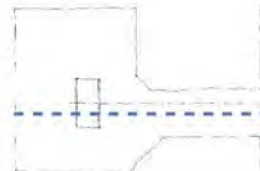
axiale und Fenster auf dem Grundriss
